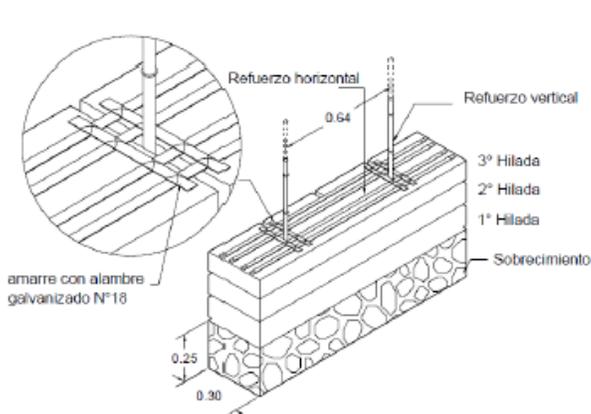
detalle de Refuerzo horizontal sin infiltraciones
